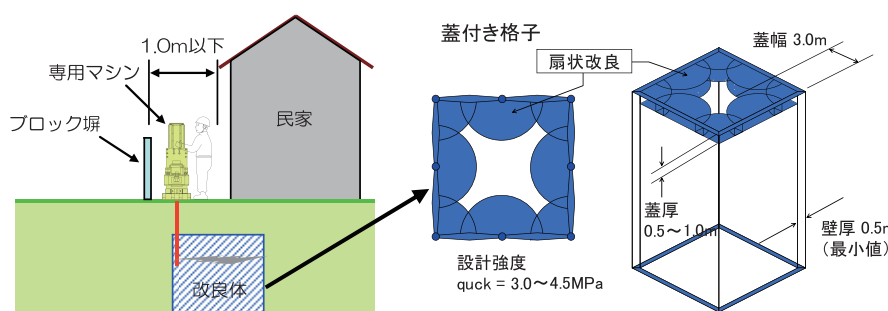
超小型施工マシンを用いた施工概略図（蓋付き格子改良）
